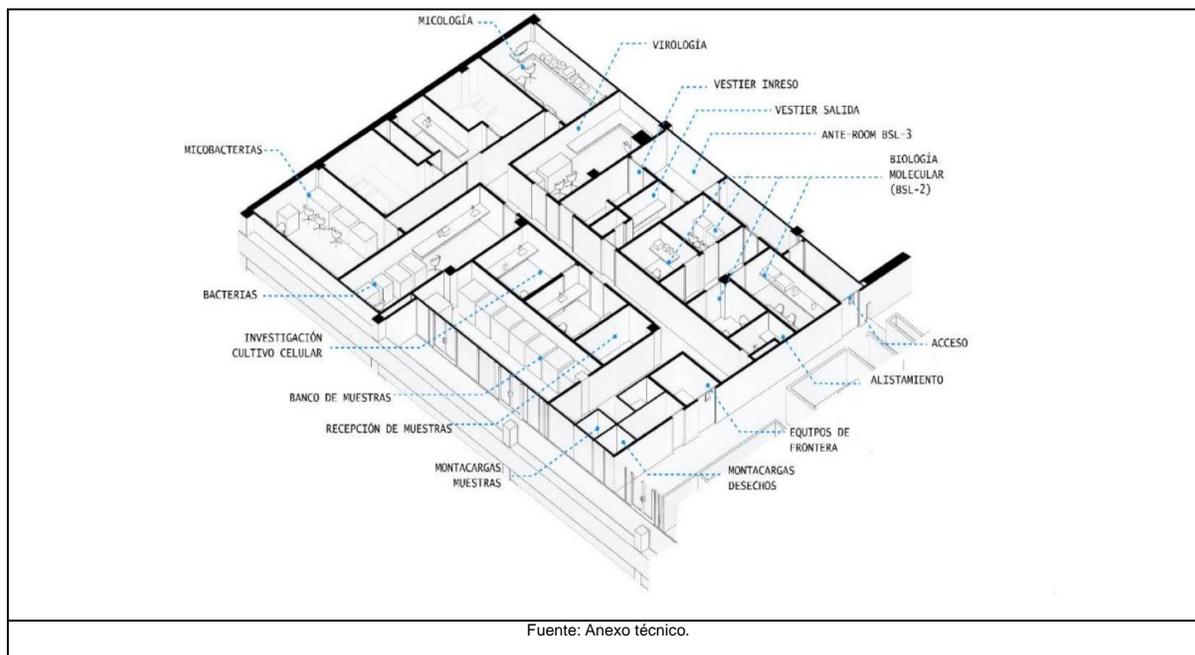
LAYOUT PROPUESTO: LAYOUT No. 6
